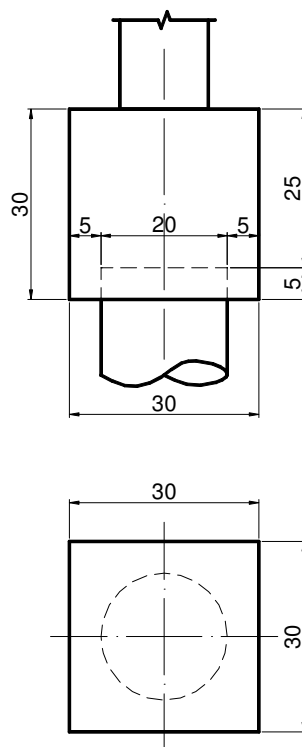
Dimensões mínimas (em cm) sugeridas para bloco sobre uma estaca em construção de pequeno porte com cargas baixas.
